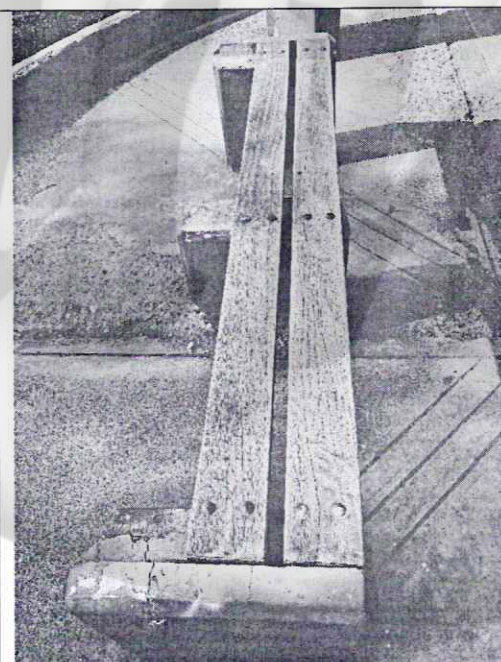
Banca de madera incompleta y despintada, y piso de concreto en mal estado.
